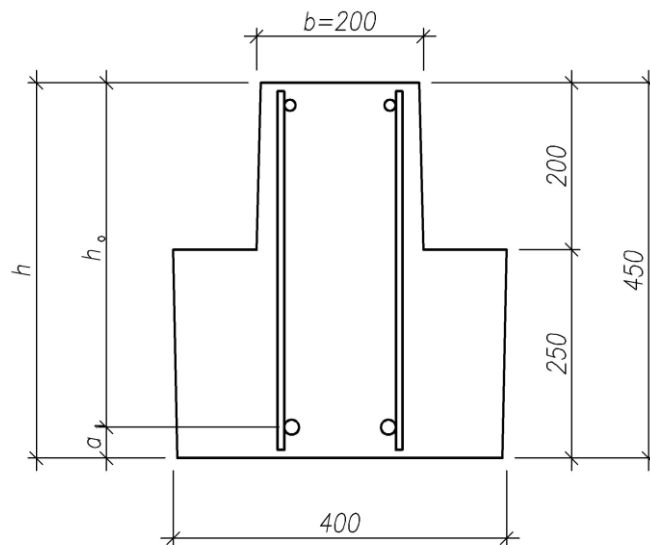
Расчетное сечение ригеля в месте обрыва арматуры
